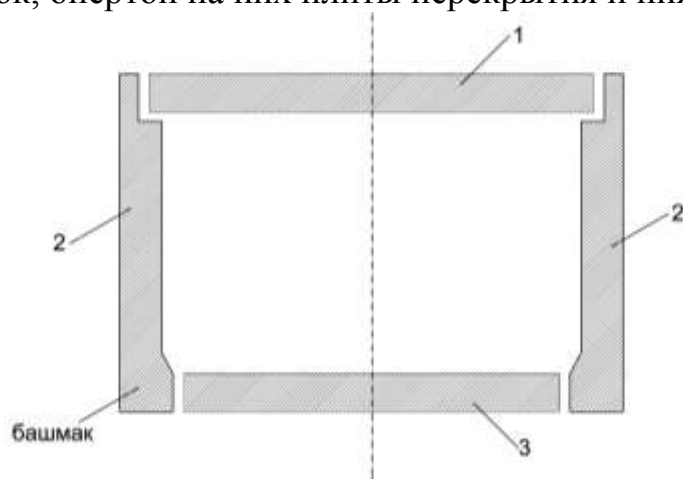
Поперечное сечение тоннеля плитной конструкции:
